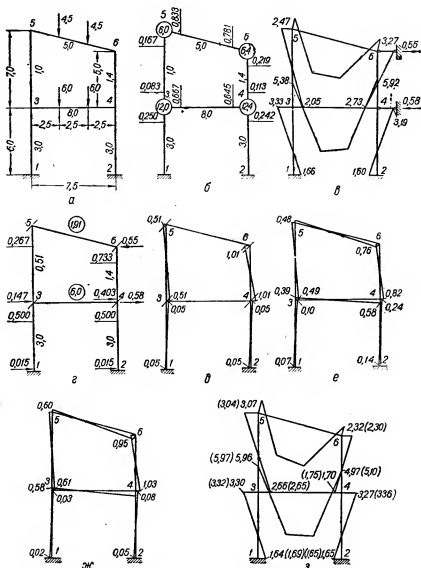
Расчет однопролетной рамы на ветровую нагрузку:
